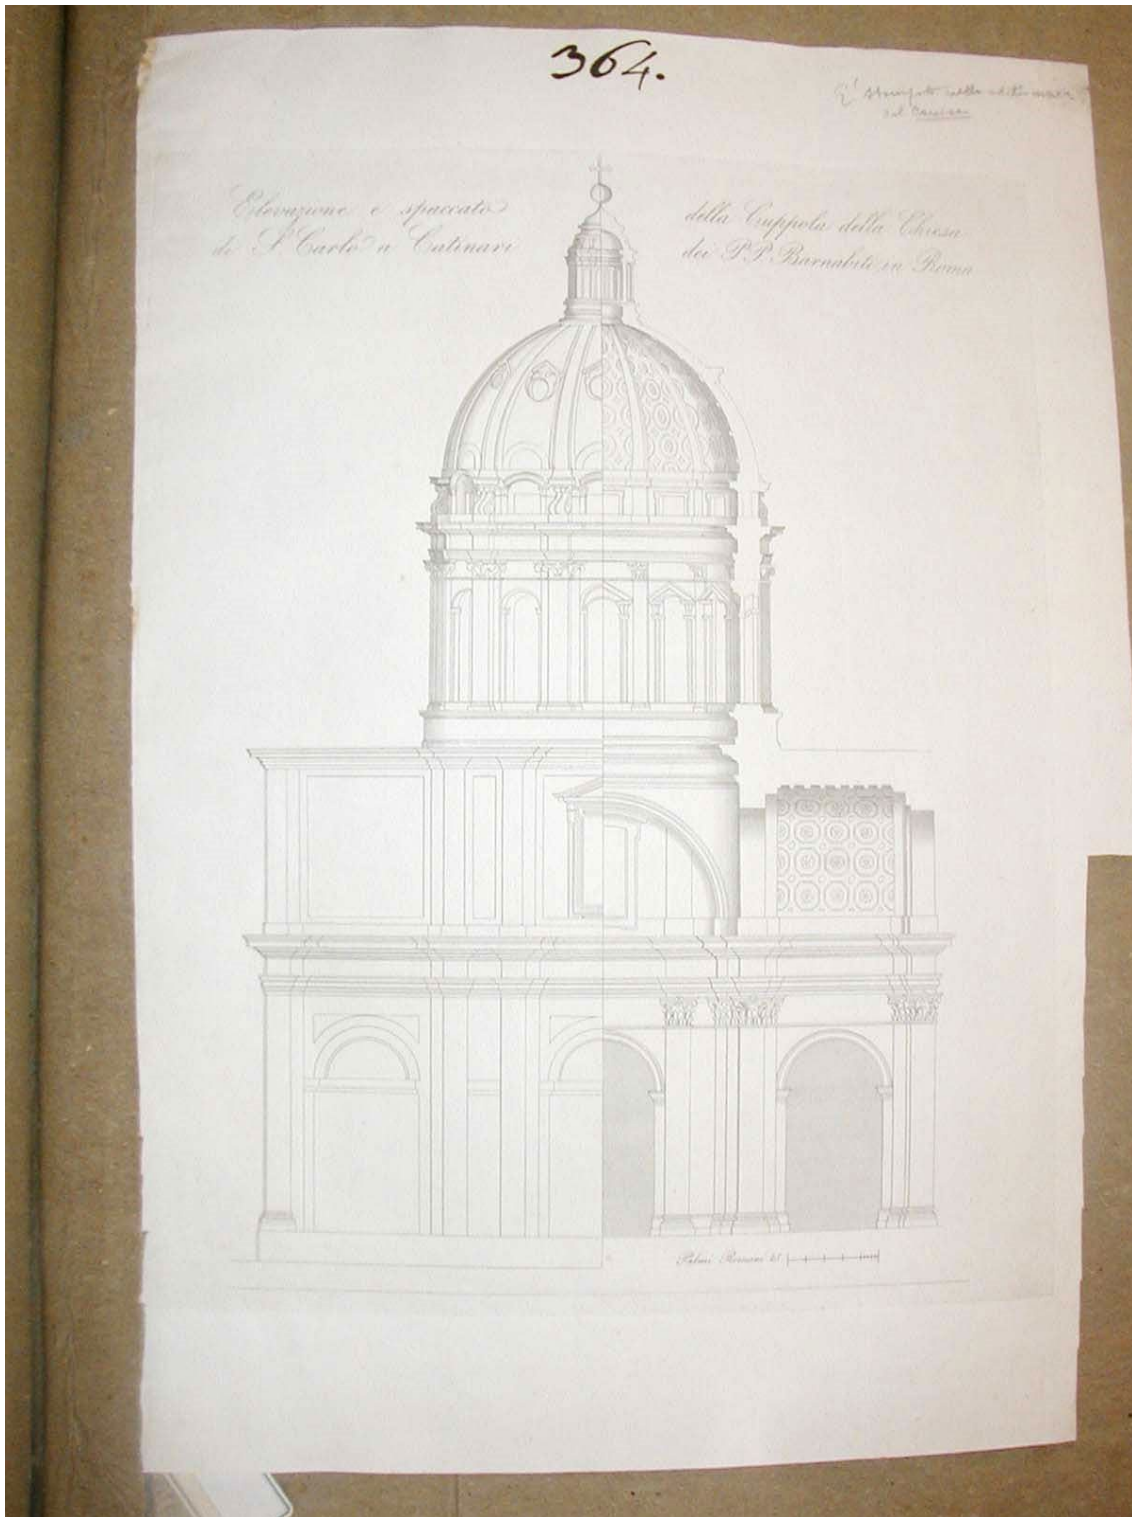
Anonimo, prospetto-sezione trasversale della chiesa (Archivio Generalizio Barnabita di Roma, f. 364)
